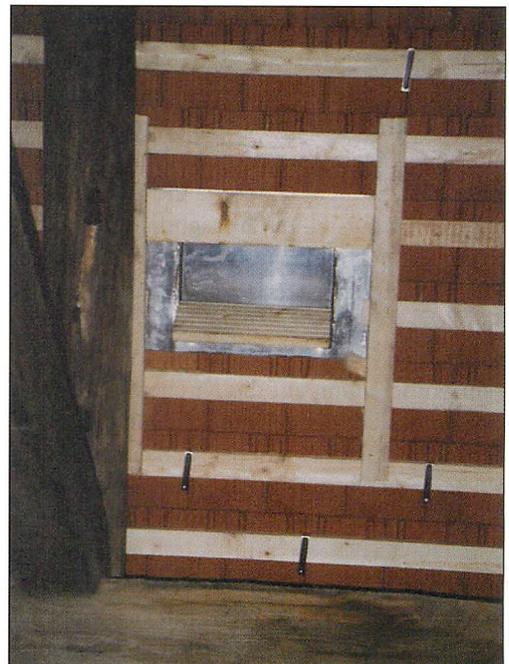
Eingebauter Dachdurchgang in der Kirche Nebra.
